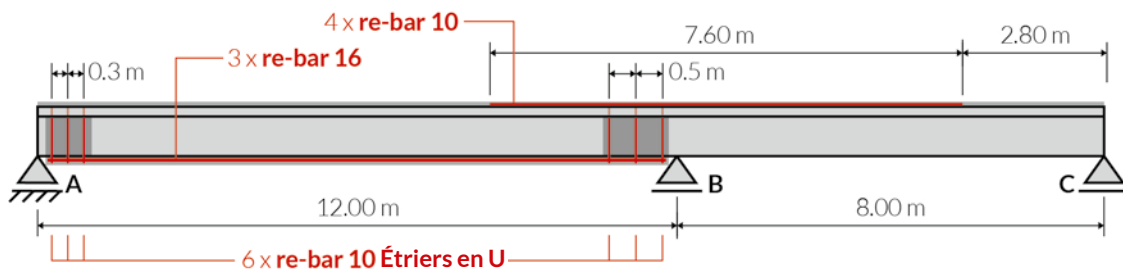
Schéma des travaux de renforcement avec re-bar armature longitudinale et étrier.
